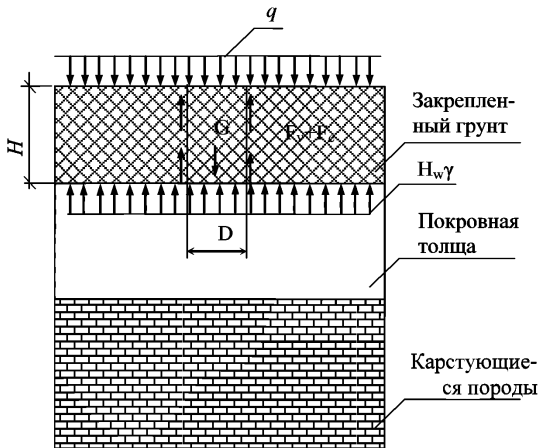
Схема разрушения укрепленного массива грунта над карстовой полостью в покровной толще
